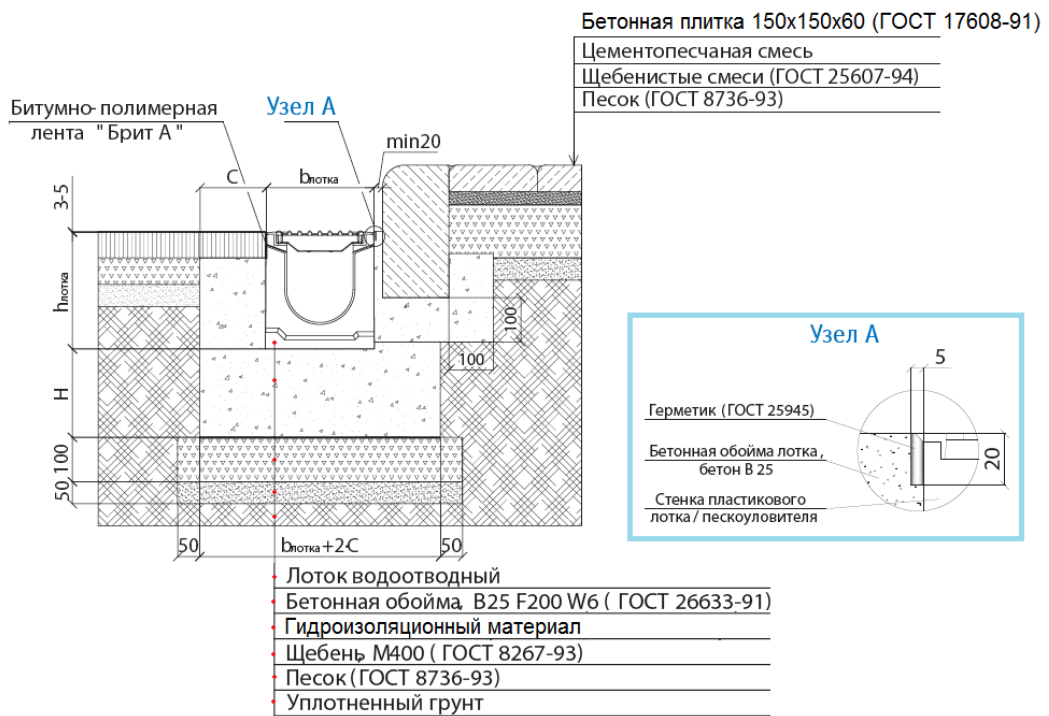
Схема установки бетонного лотка у бордюрного камня, класс нагрузки D400 E600
